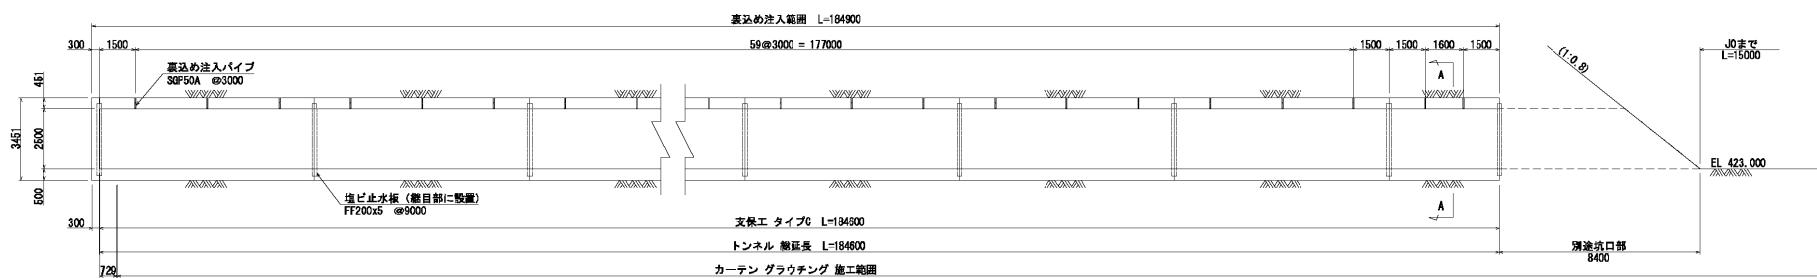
リムグラウト平面図(令和 2 年度 鳥海ダム本体実施設計業務より)
